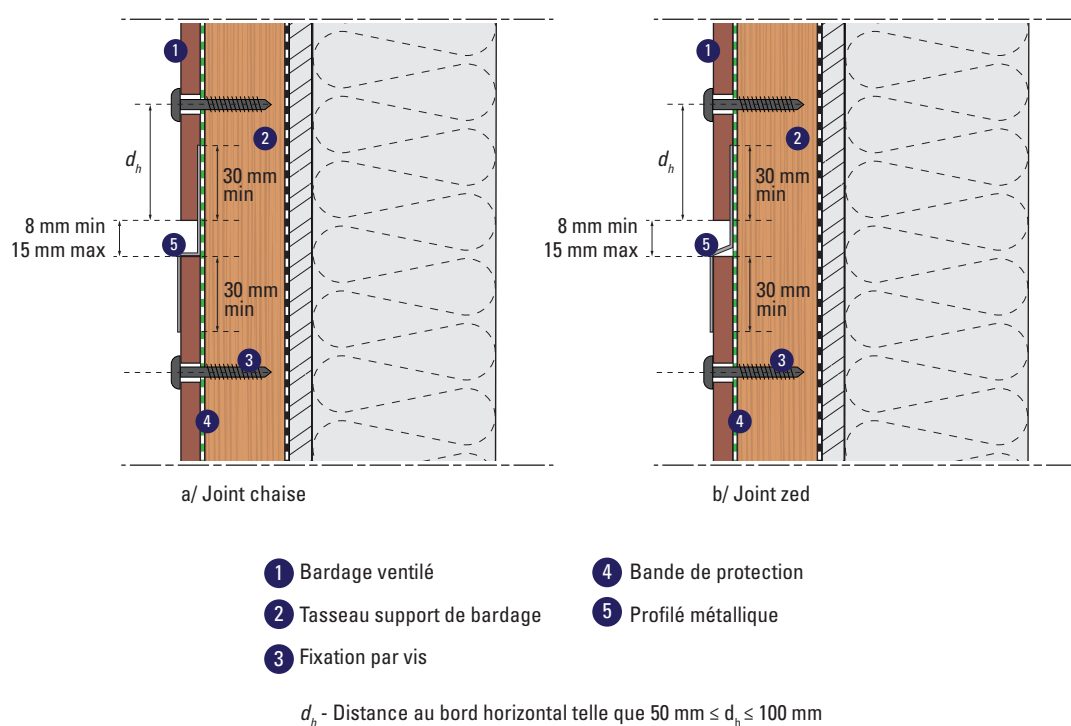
Exemples de traitement des joints horizontaux pour joints fermés – coupe verticale
